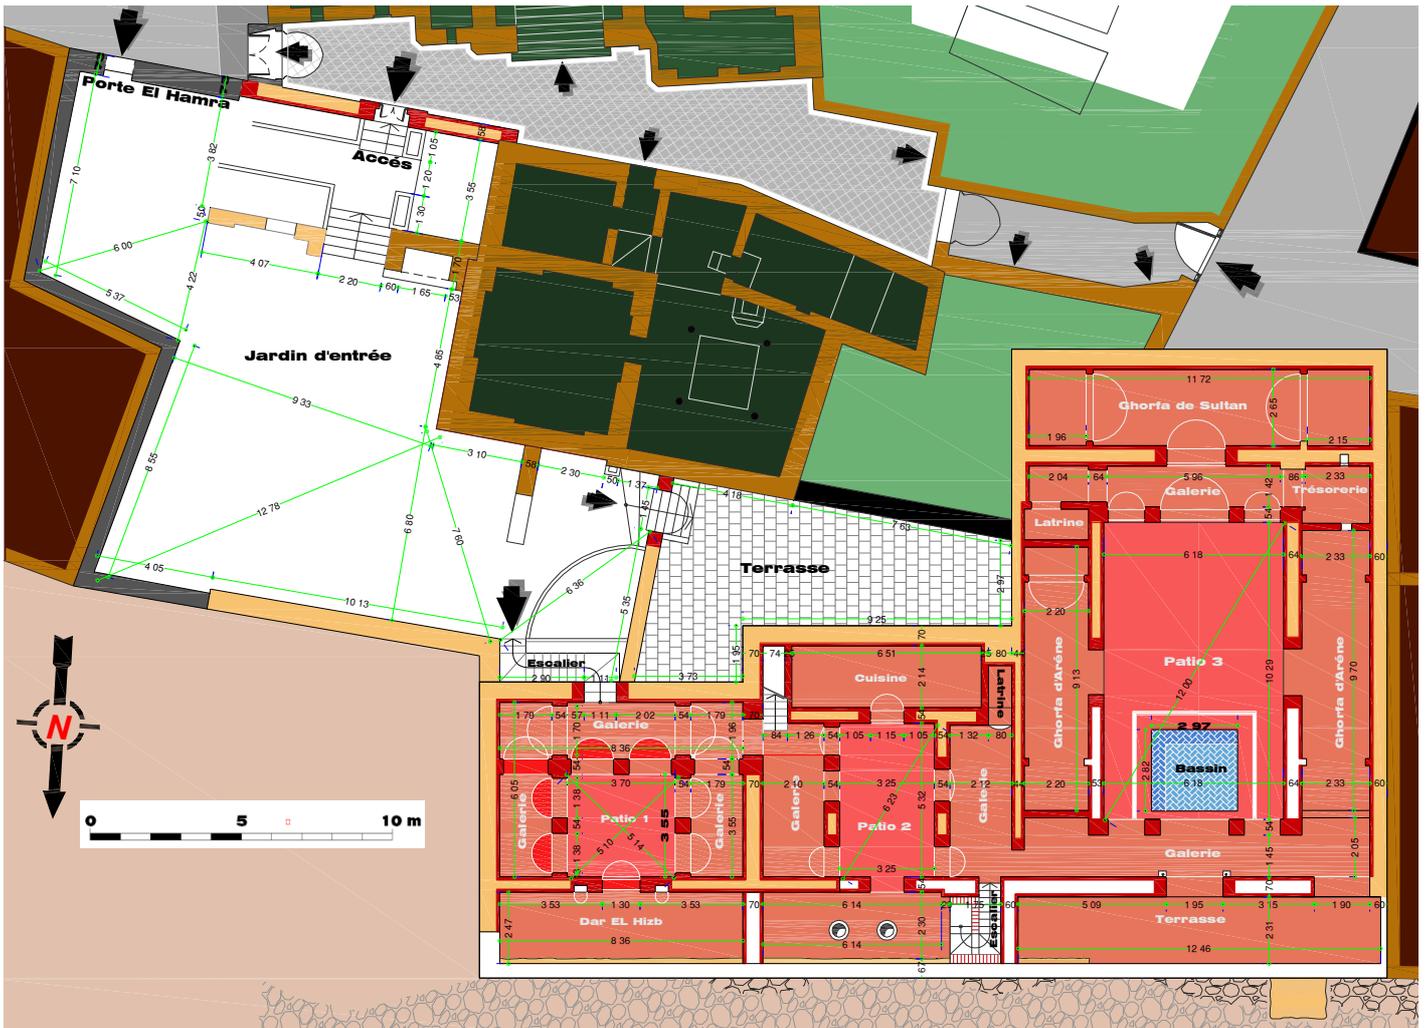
Plan de l'état des lieux, Rez De Chaussée Existant.
